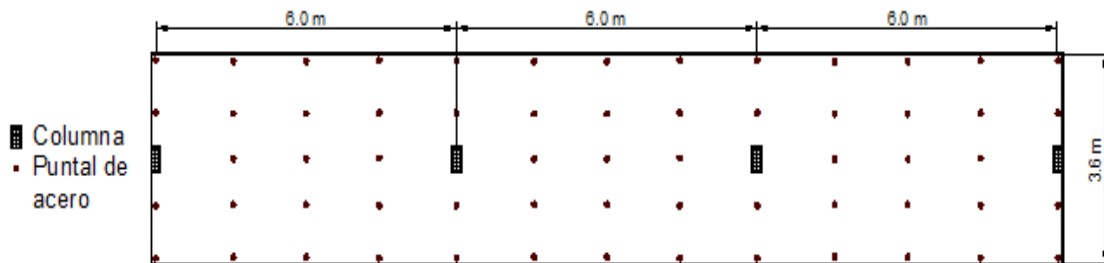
Planta típica del modelo en pórtico de tres vanos.
